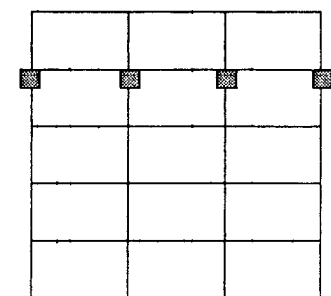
Tingkat 5 lantai ke 1
